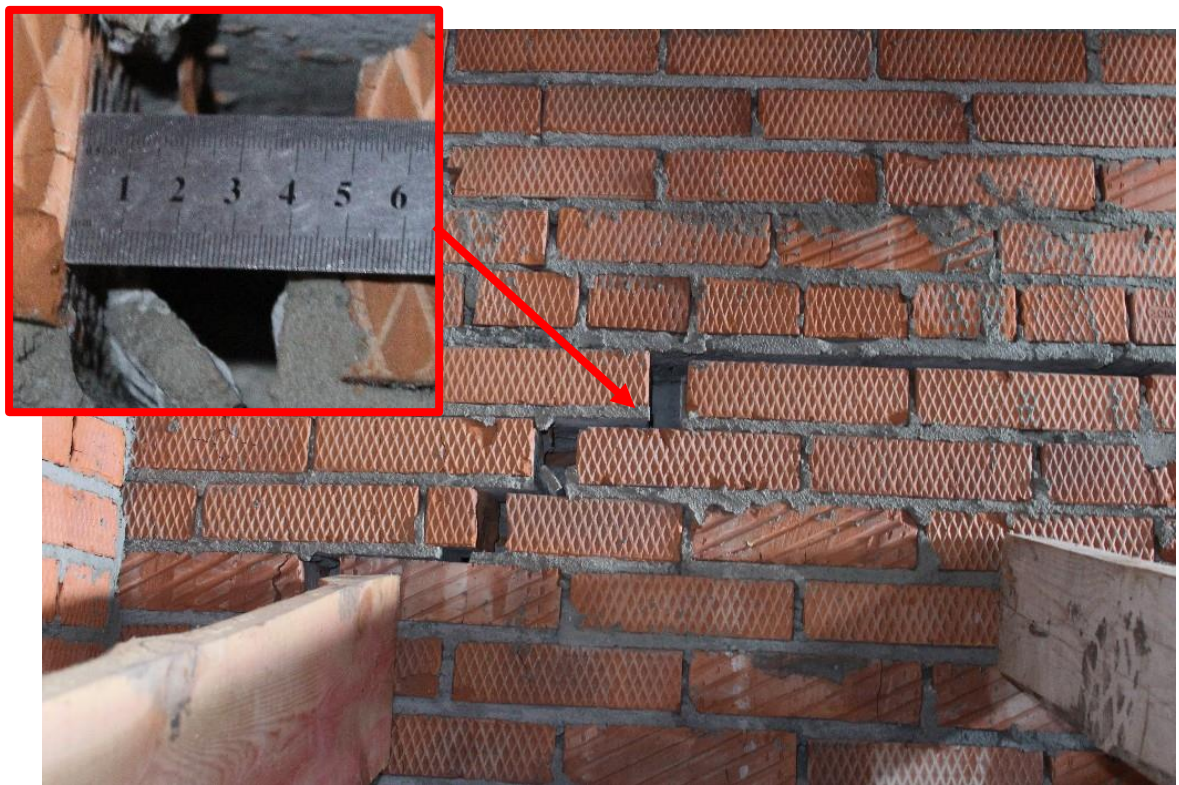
Трещина в кладке несущей стены по оси 2, ширина раскрытия 50 мм
